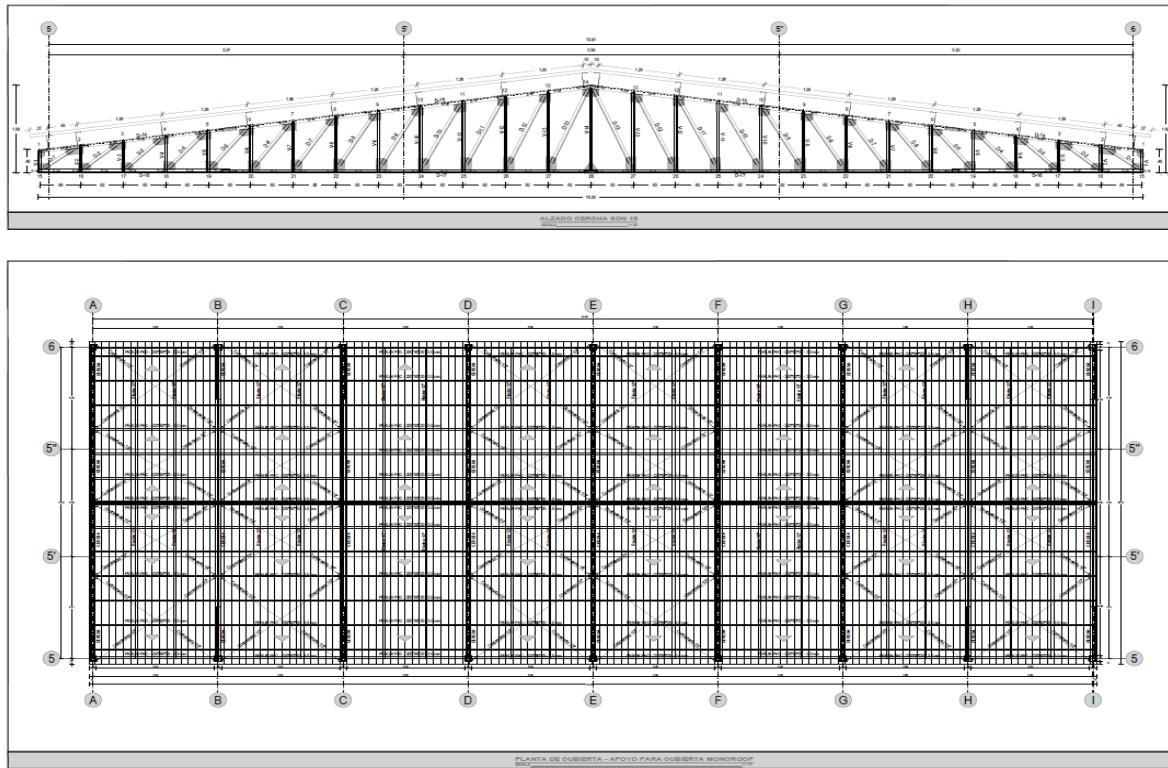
Diseño Estructural de Cubierta a Instalar
